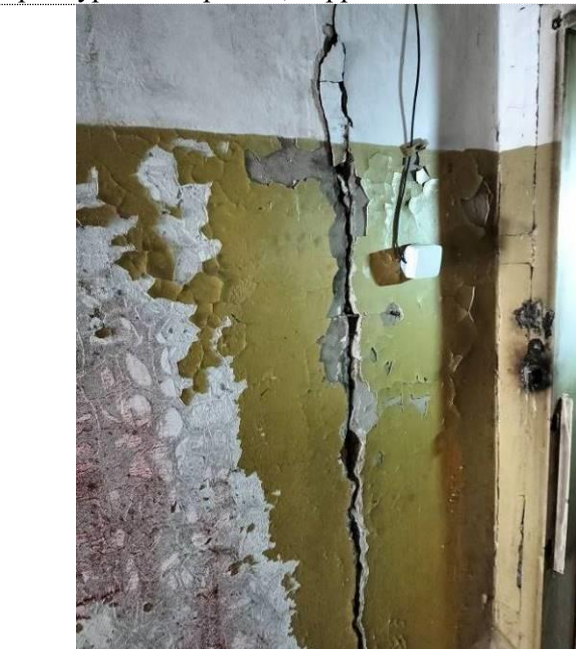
Трещина в месте примыкания перегородки 1 этажа к наружной стене в районе осей 7/Б
